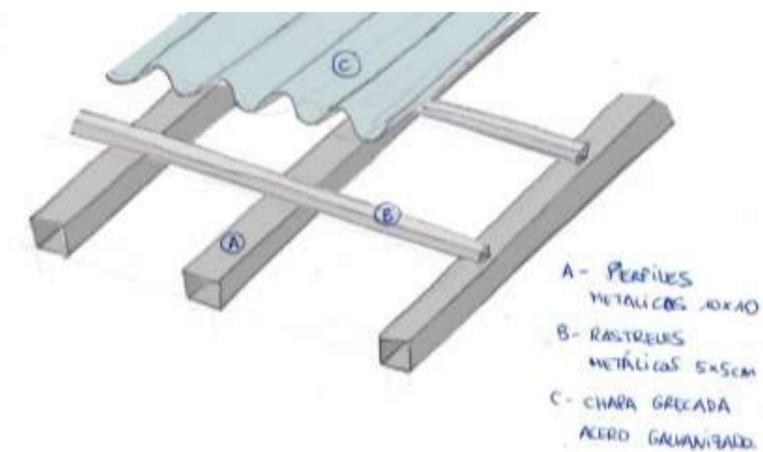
cubierta metálica TIPO 4. Elaboración propia.
